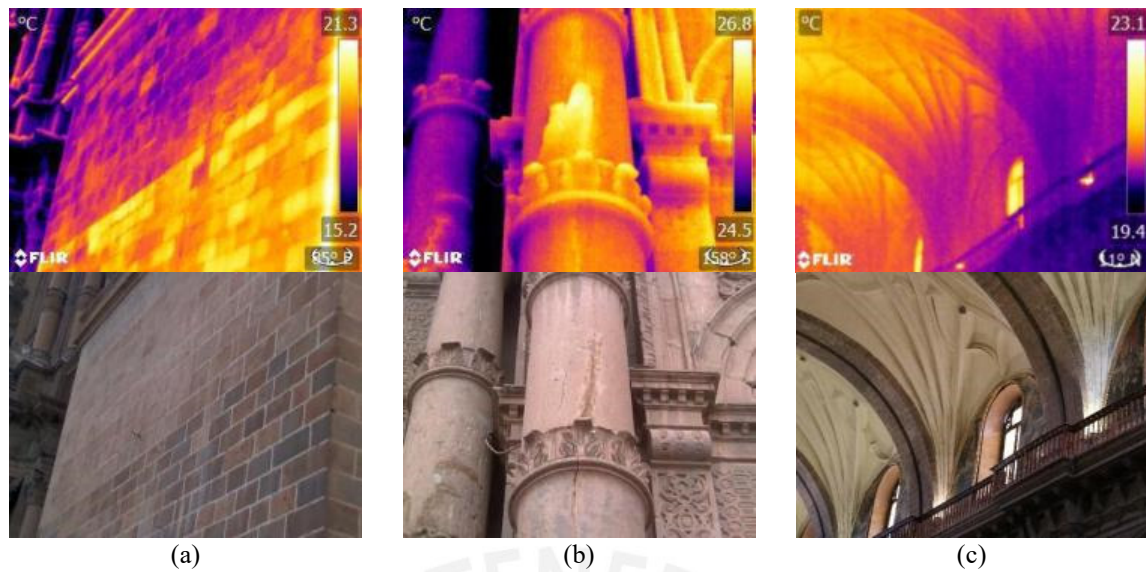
Identificación de anomalías estructurales en el ensayo de termografía infrarroja inactiva: (a) fachada exterior de la torre campanario, (b) grietas y desprendimiento de un pilar, (c) intradós de la bóveda de crucería de la nave principal.
